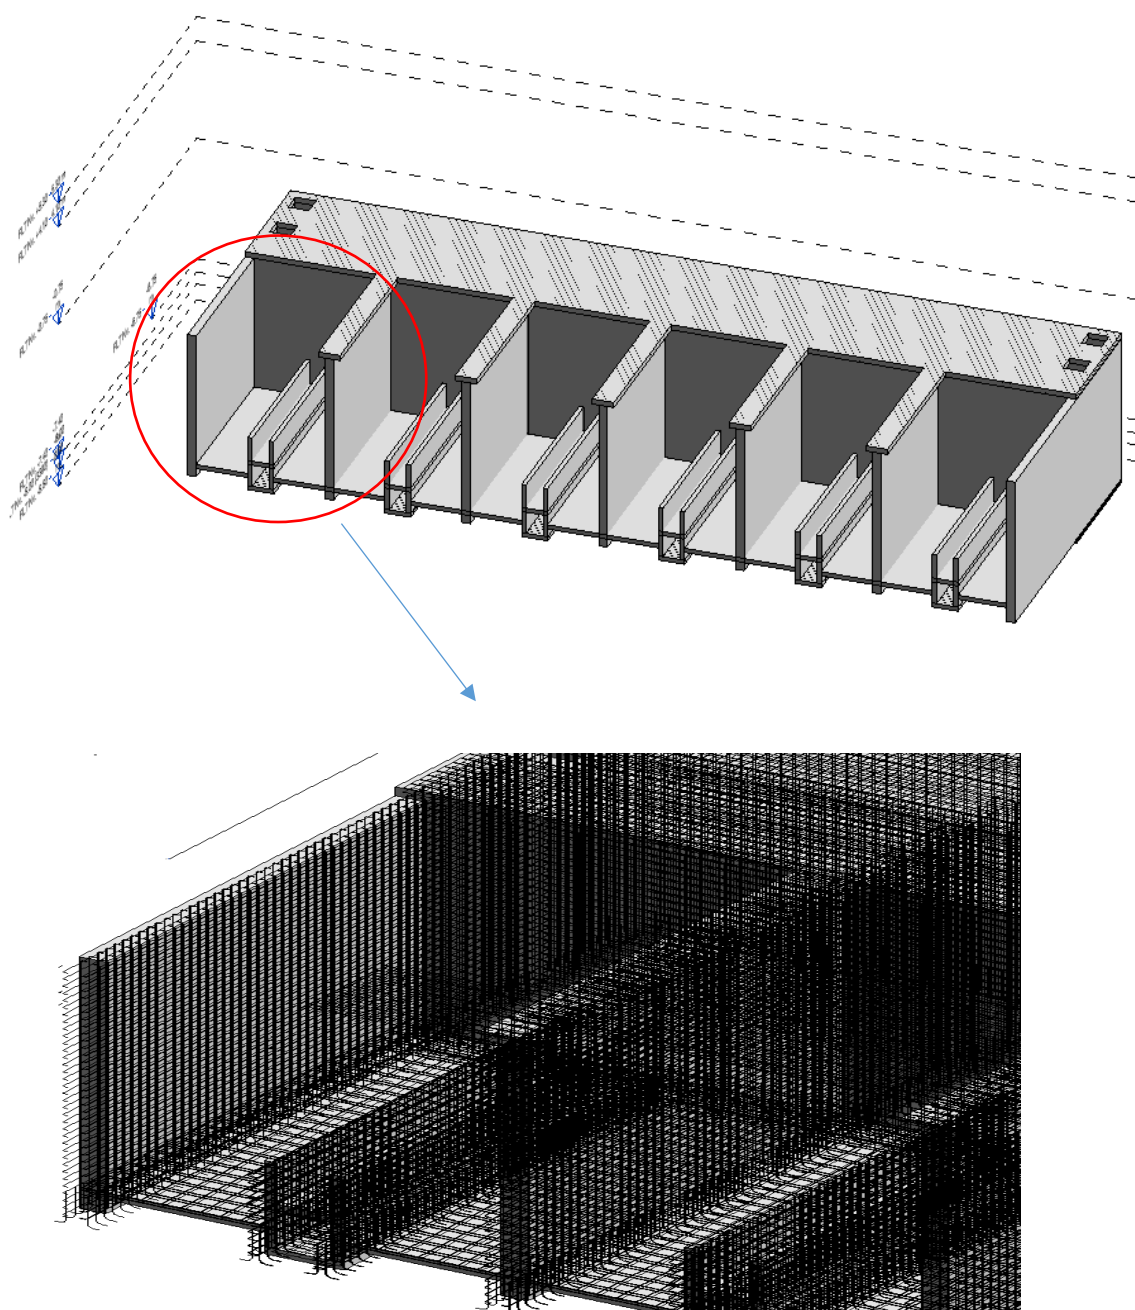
Isometría modelación estructural área de Filtros FLT y muros verticales
